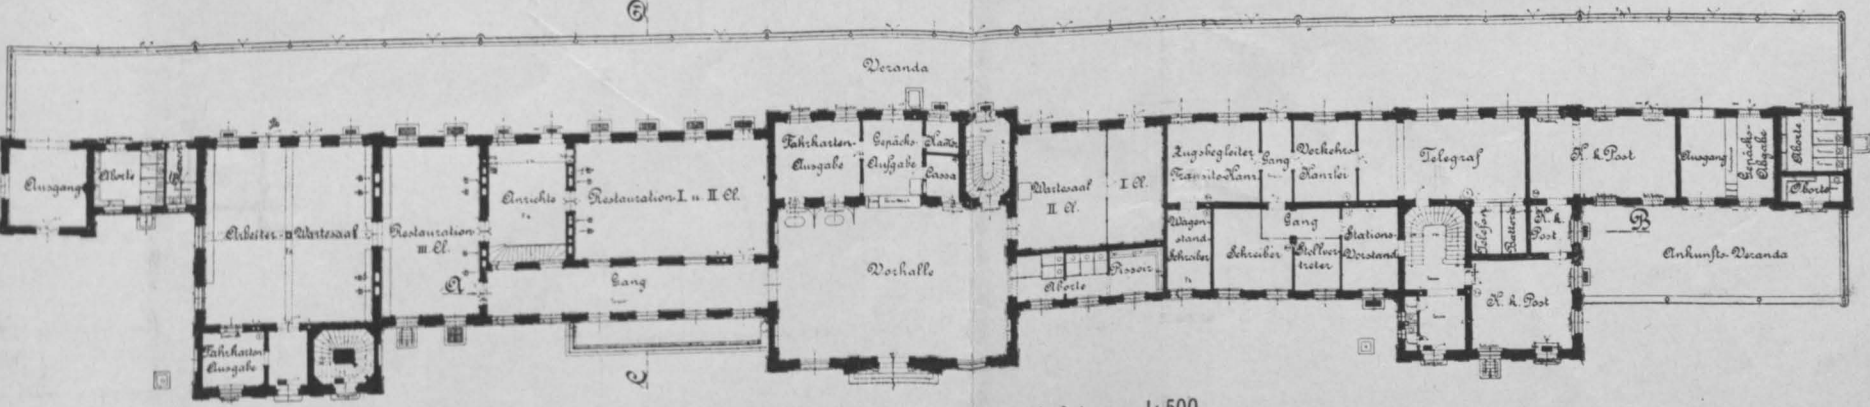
Grundriss des Aufnahmegebäudes in M.-Ostrau. 1:500.
